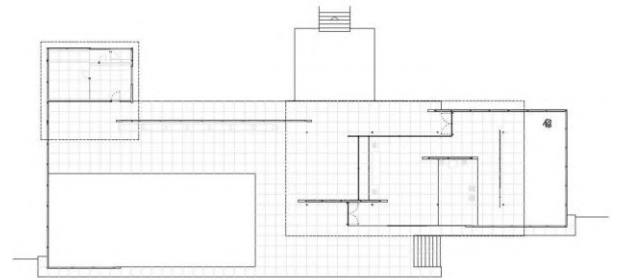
Planta Pabellón Alemán. Fuente: ArchDaily.
